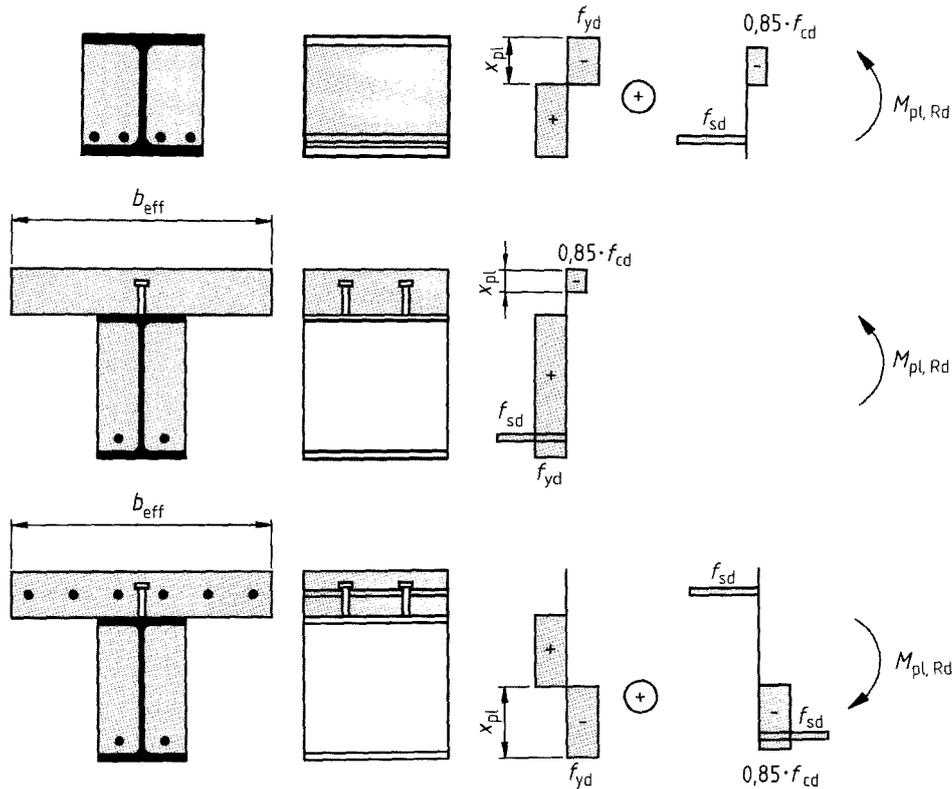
Typische Querschnittsausgestaltung bei kammerbetonierten Trägern
